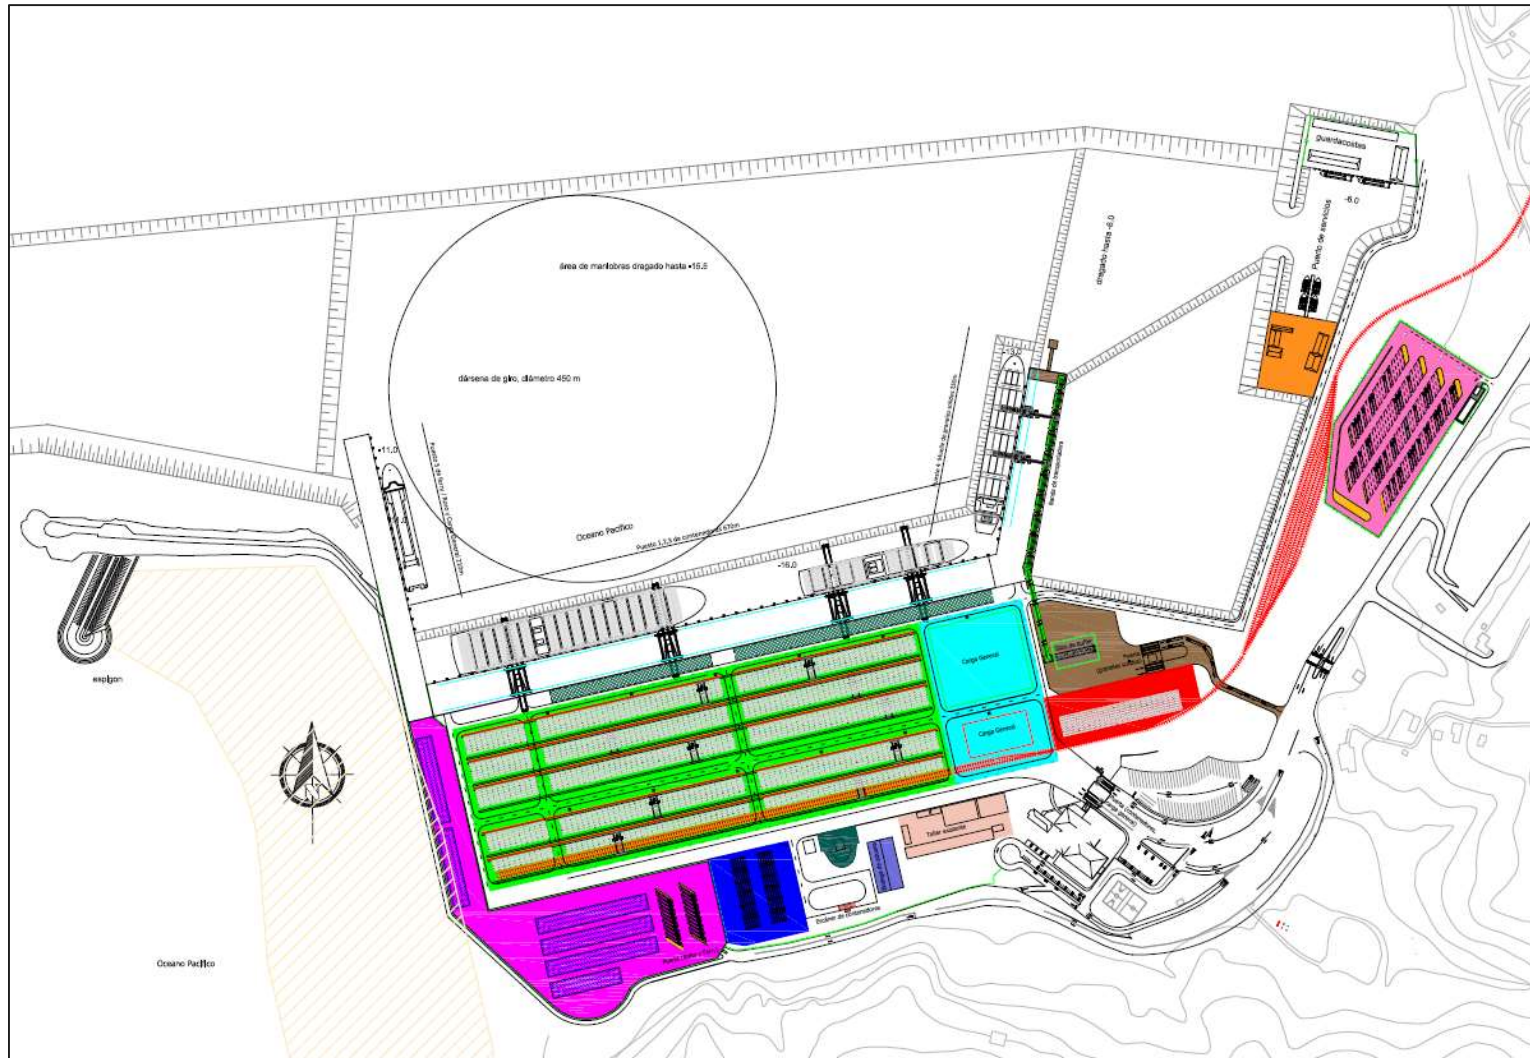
Plan Maestro de Puerto Caldera con puesto 1 y 2 extendido con 100m
